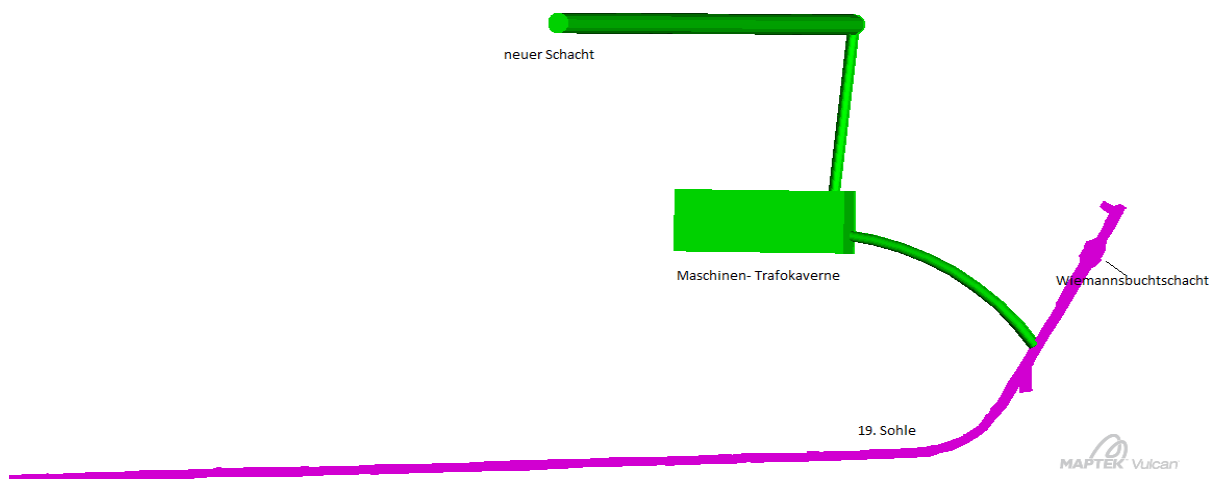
Maschinen-Trafokaverne - Draufsicht
